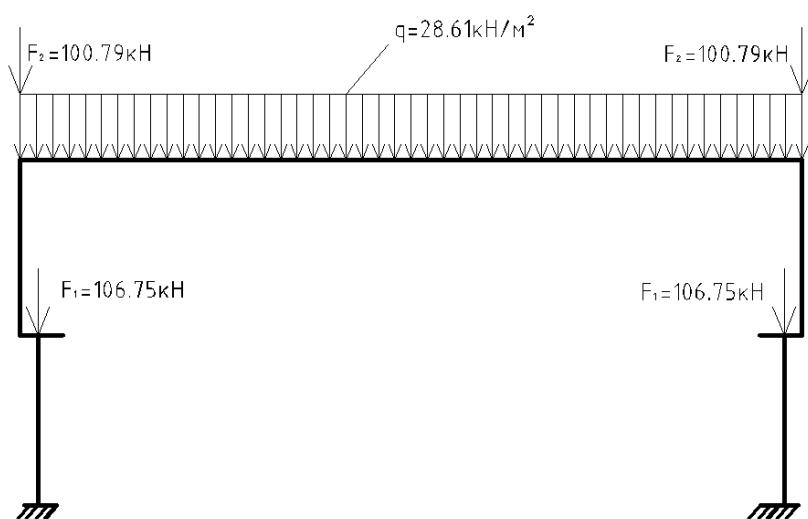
Расчетная схема при постоянной нагрузке от веса покрытия и фермы.
